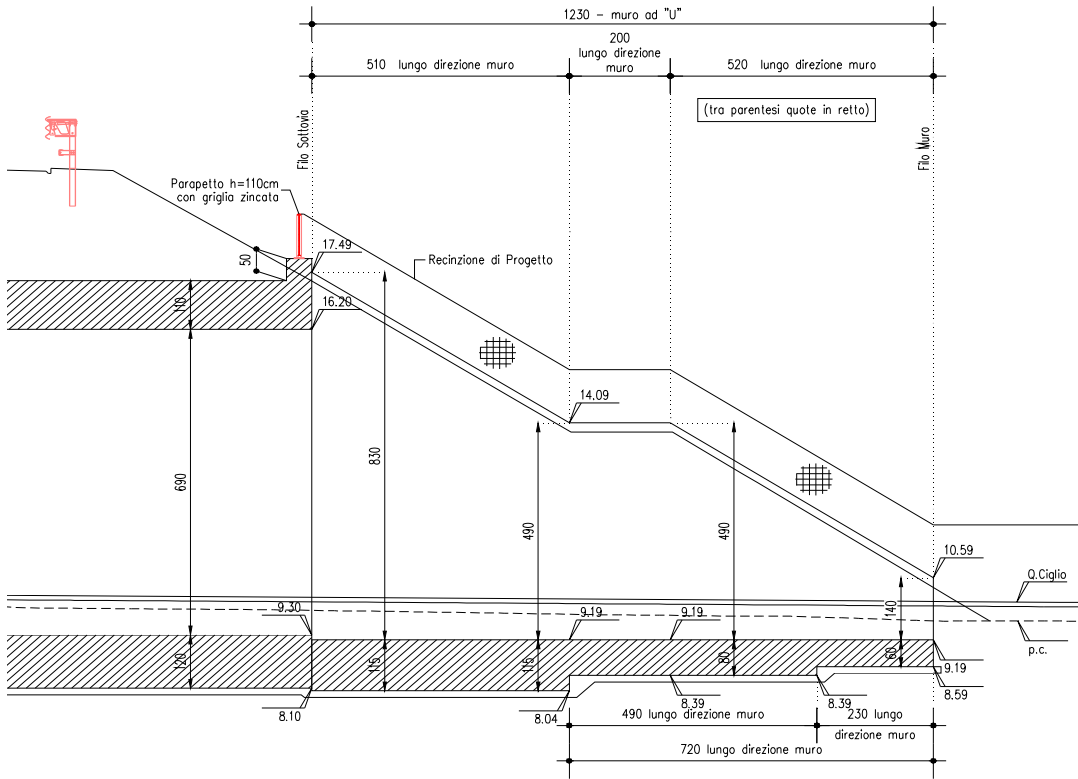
SEZIONE LONGITUDINALE MURI
